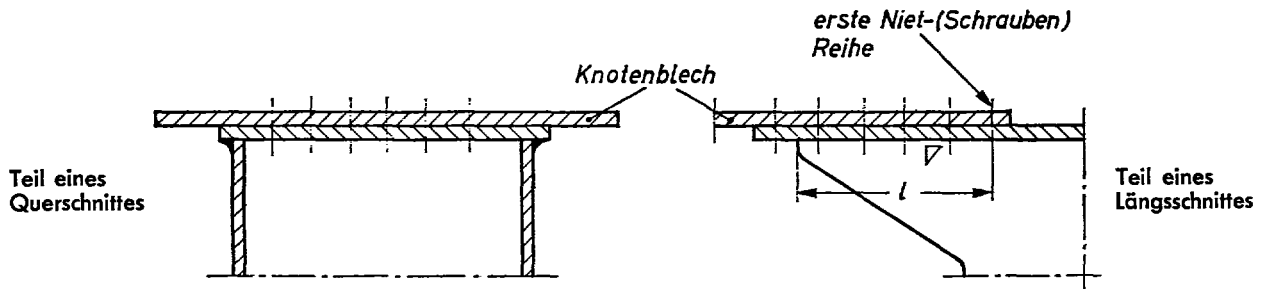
Nahtlänge im genieteten oder geschraubten Anschluß geschweißter Bauteile mit zusammengesetztem Querschnitt
